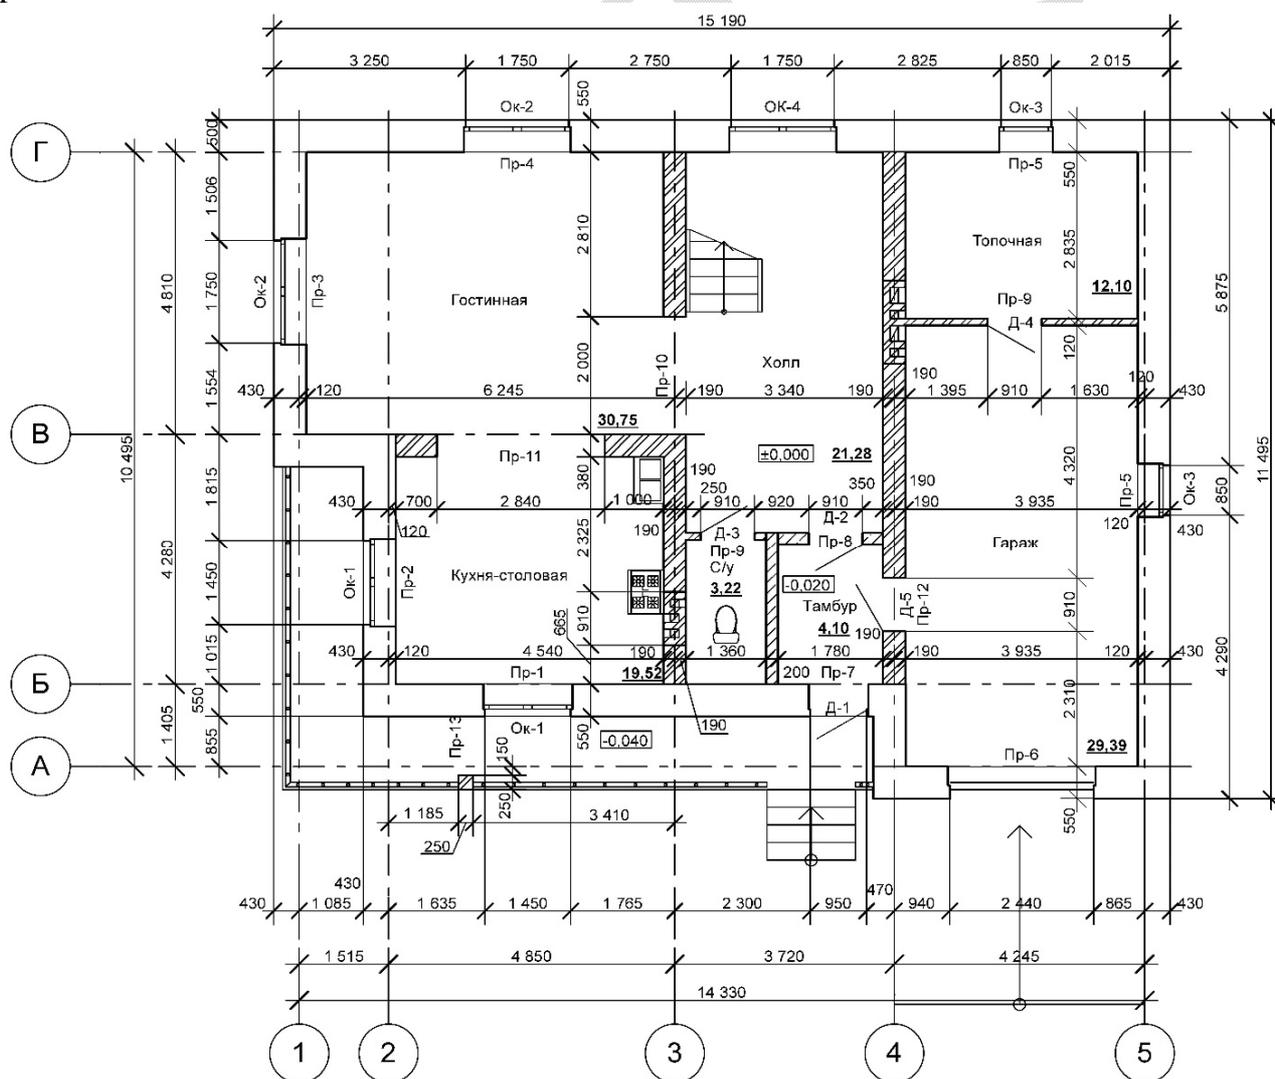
Пример плана этажа, выполненный в ArchiCad 16
